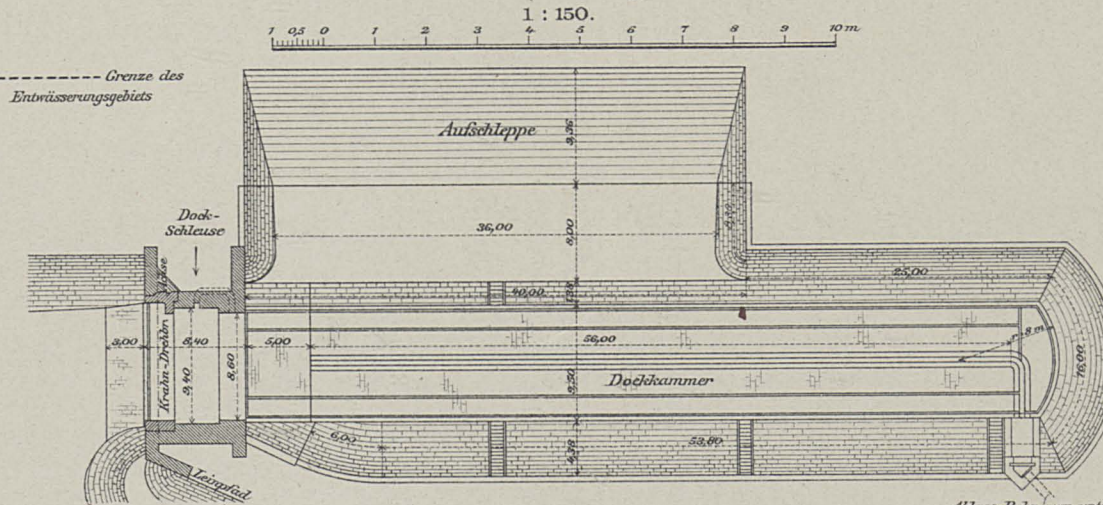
Grundriss des Docks. 1: 600.
